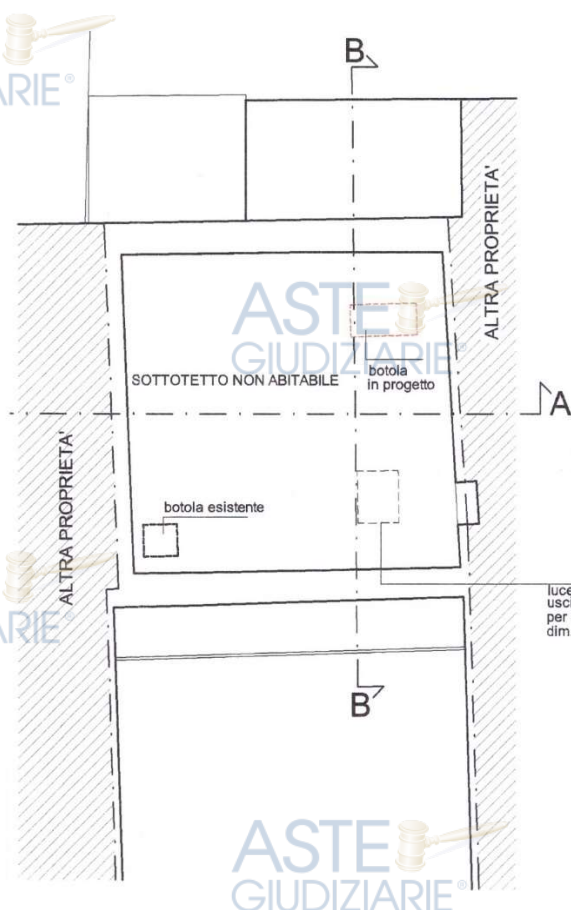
Planimetria del piano sottotetto allegata alla DIA del 2005
